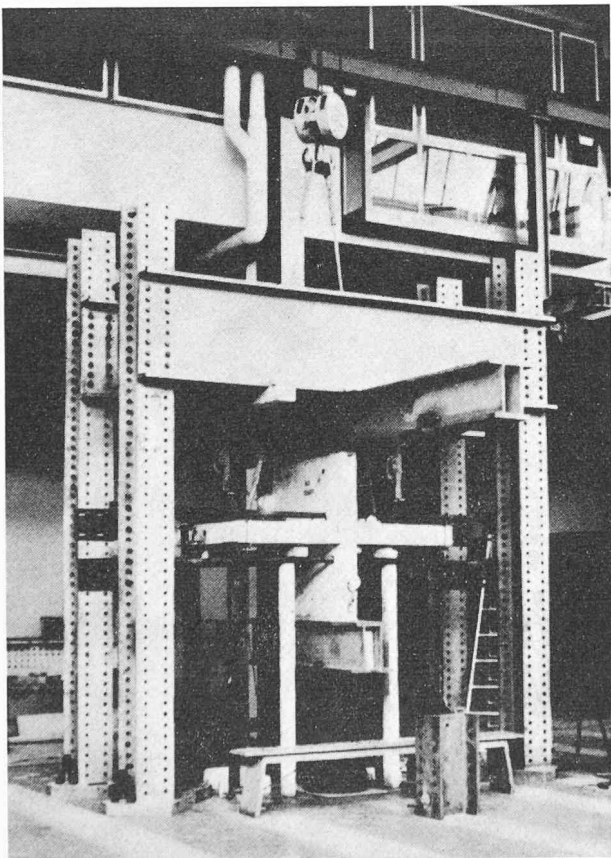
EMPA ; disposition pour l'essai d'un assemblage « en croix ».
